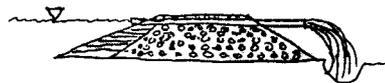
Querschnitt durch Filtrierdamm; 1- feinkörnige Sande, 2- grobkörnige Sande, 3- Schotter, 4- Wasser
